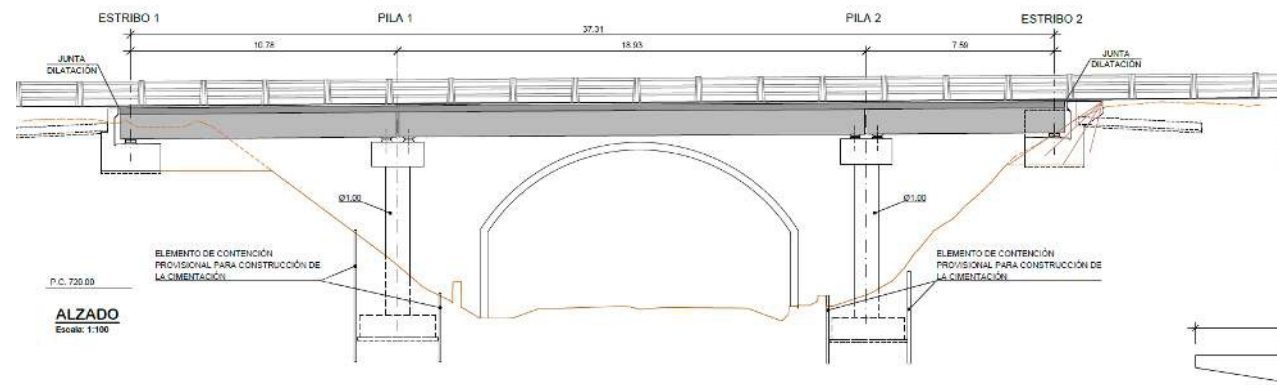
Sección longitudinal. Estructura E-5. Alternativa 3B
